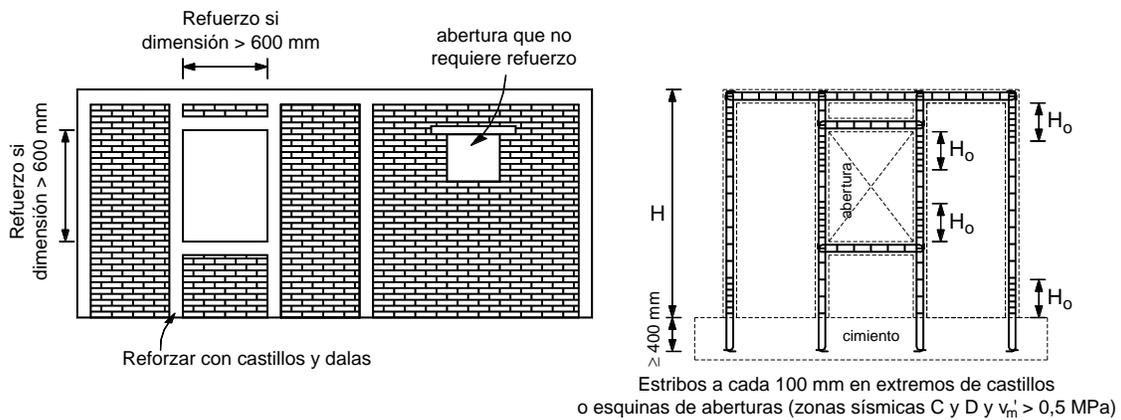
Refuerzo en el perímetro de aberturas en zona sísmica C y D
